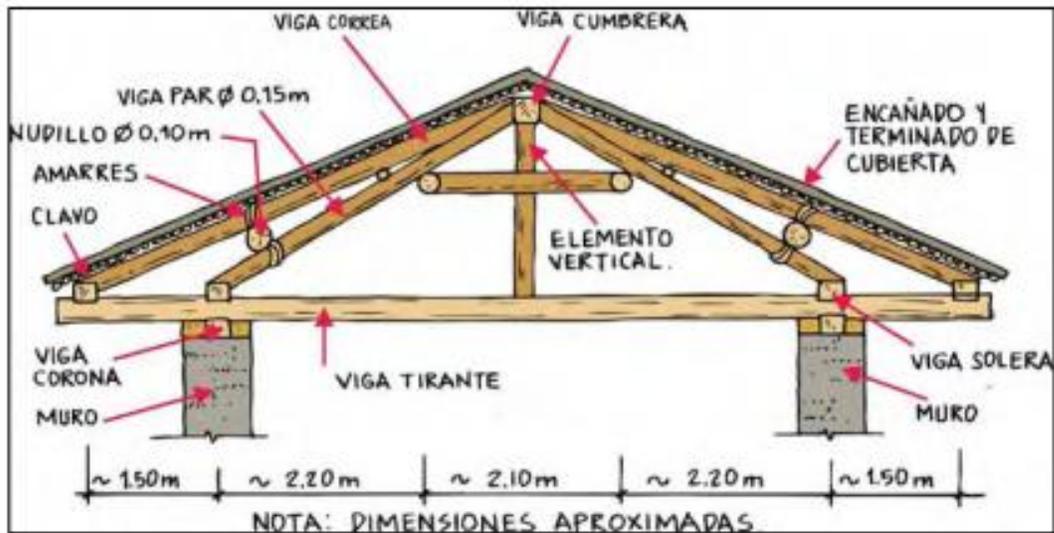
Sistema estructural de techo para una vivienda de adobe.
